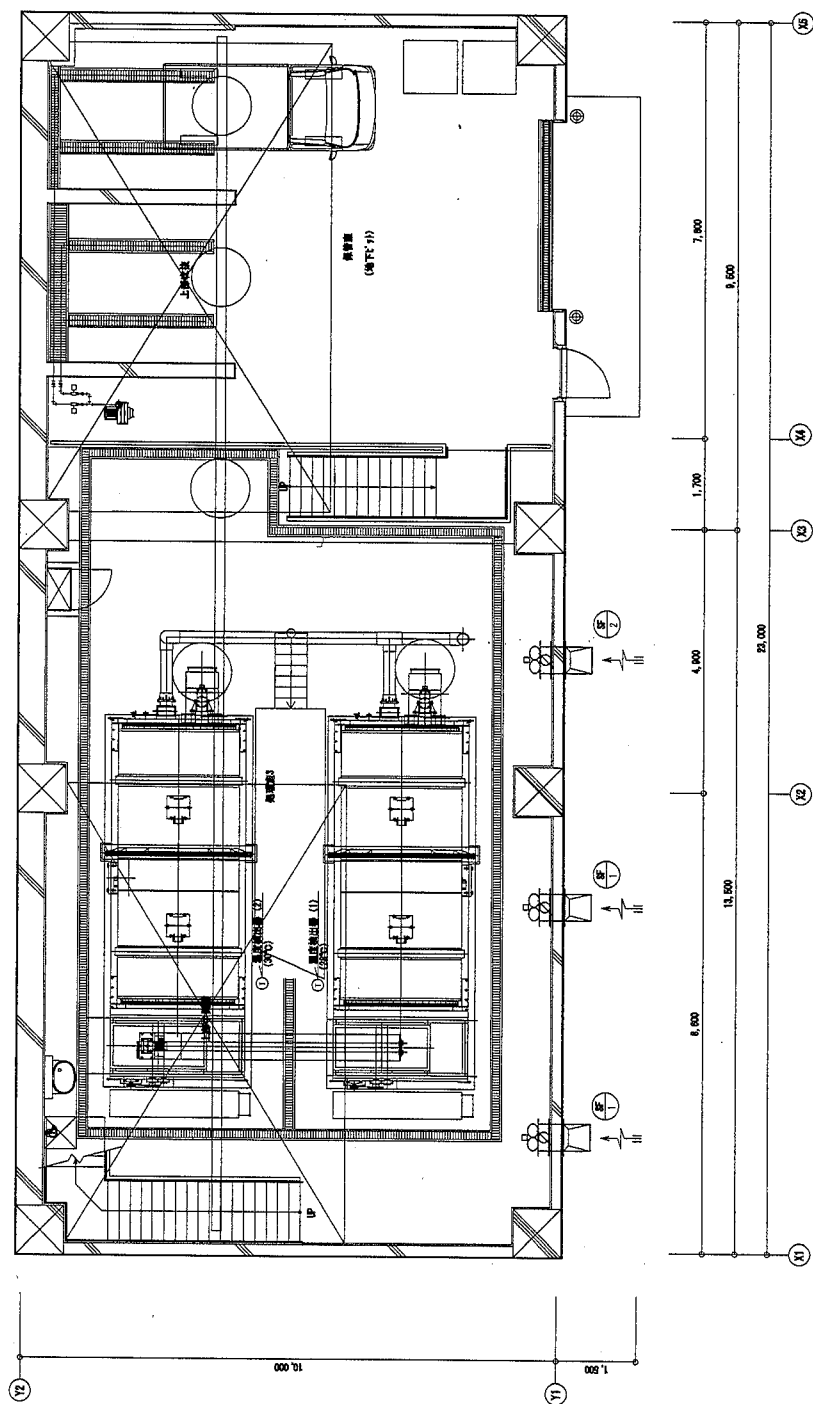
バイオ発酵処理施設 暖房設備 1階・B1階平面図
